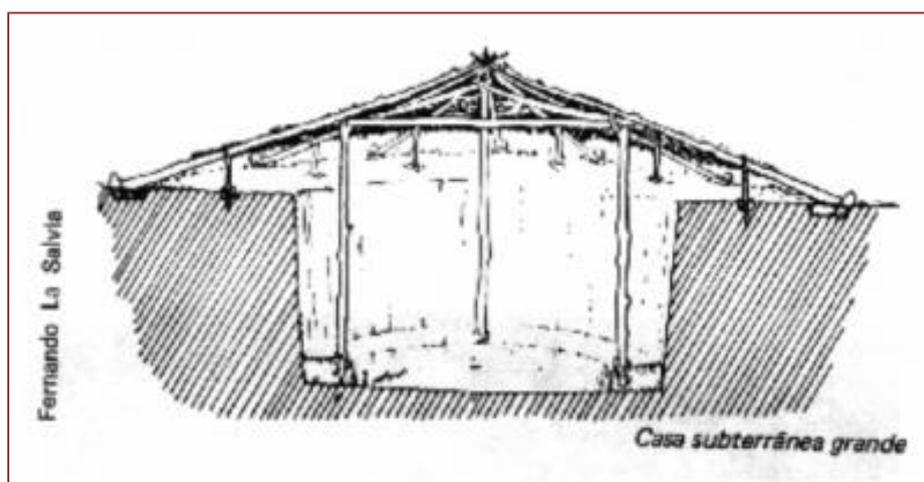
Planta de cobertura e corte esquemático casa subterrânea
